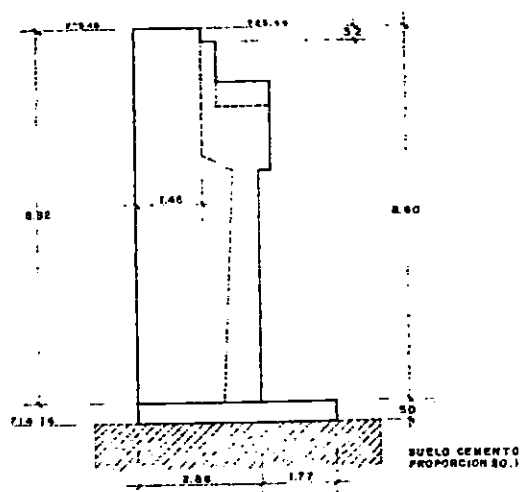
ELEVACION ALA ESTRIBO
